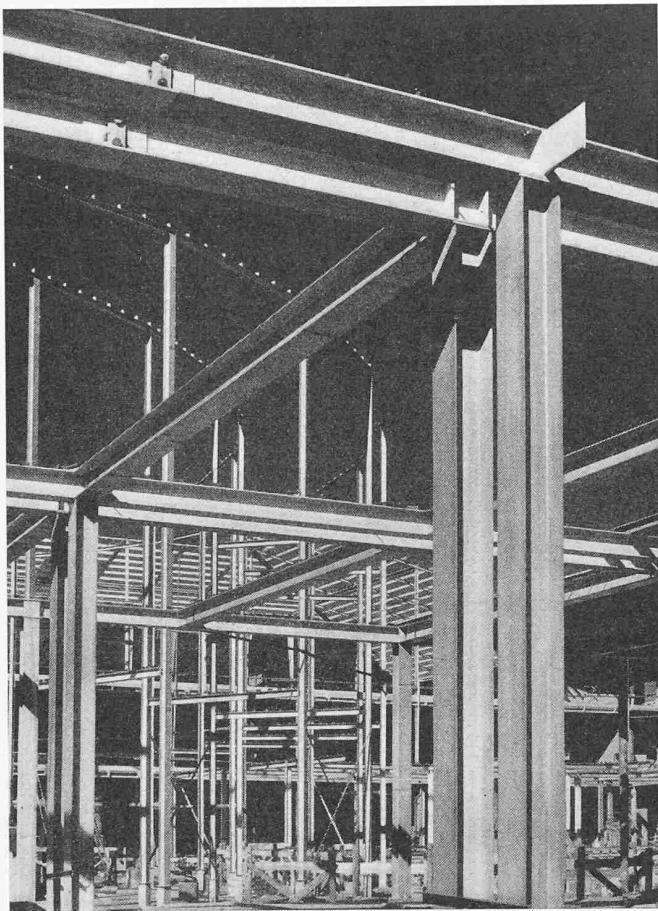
Stahlmontage, im Vordergrund Anschlussblech für Querträgeranschluss
